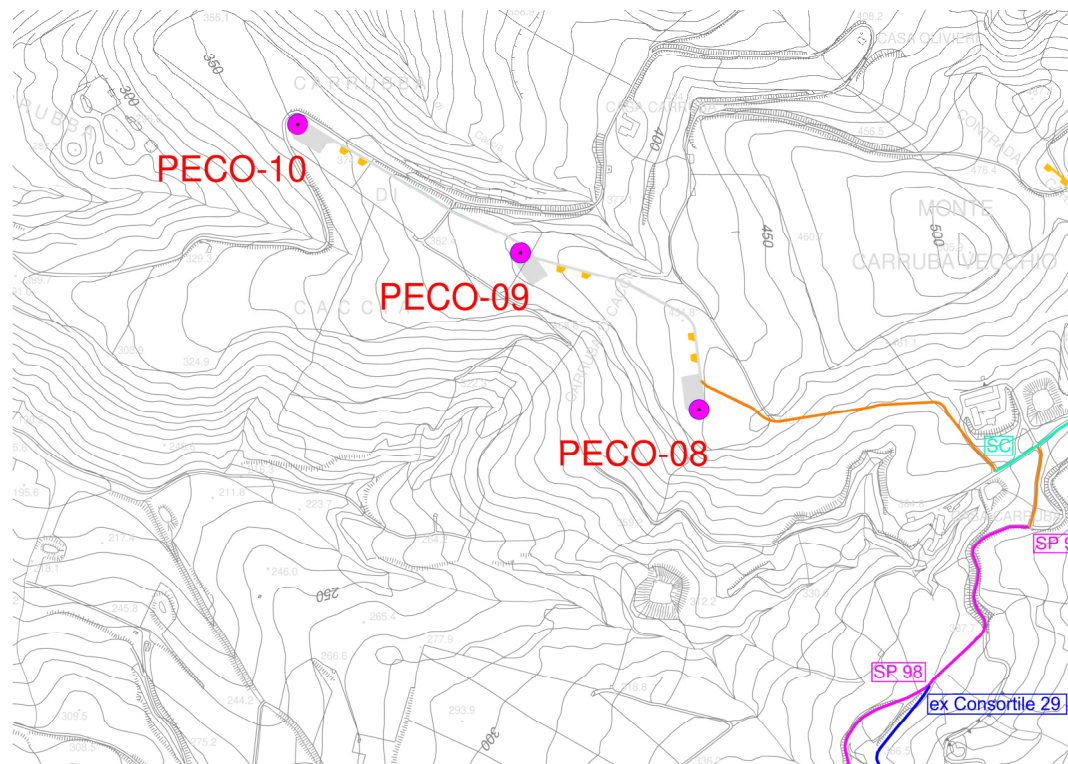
Planimetria delle strade di cantiere scala 1:5.000
